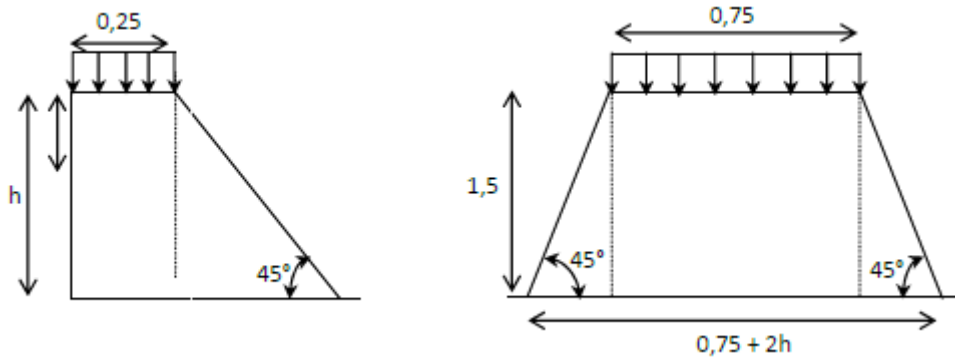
Poussée de la charge locale située en arrière du mur.
